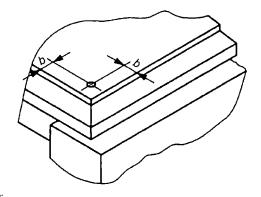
Конструкційне монтування прямокутних крайок, що укладають поперек на балках та утримують фахверками
